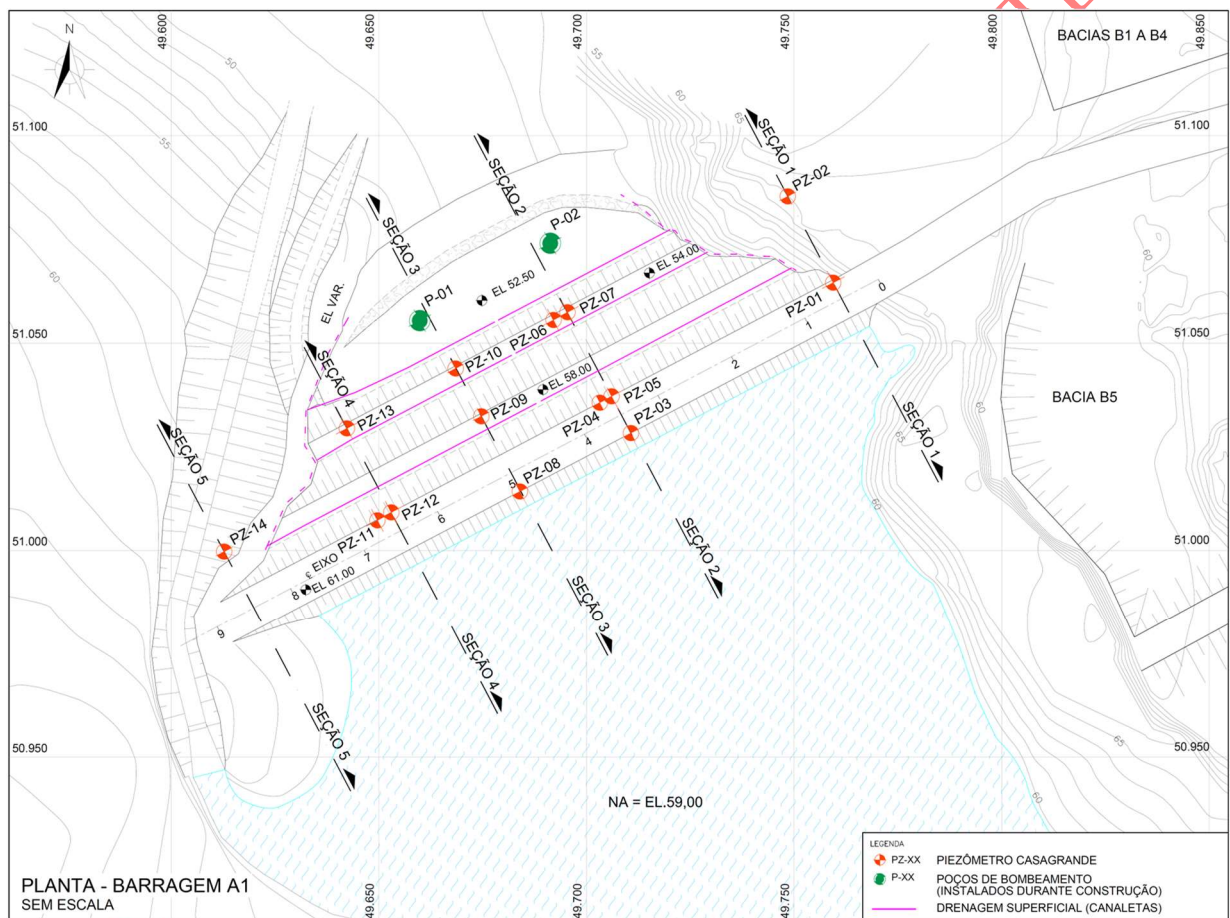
Planta esquemática de localização dos instrumentos existentes na Barragem A1
